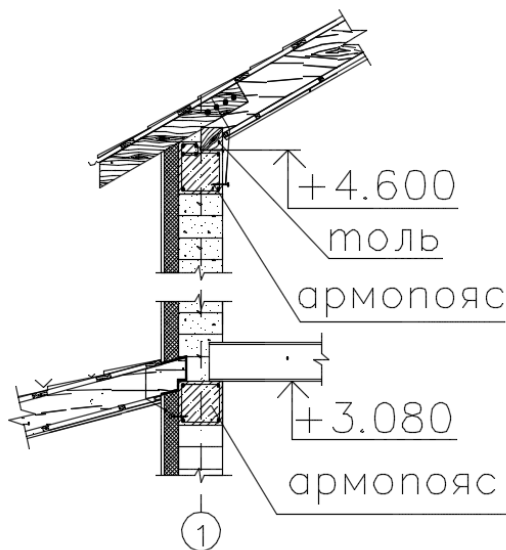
Расположение армопоясов. Опираие конструкций на армопояса
